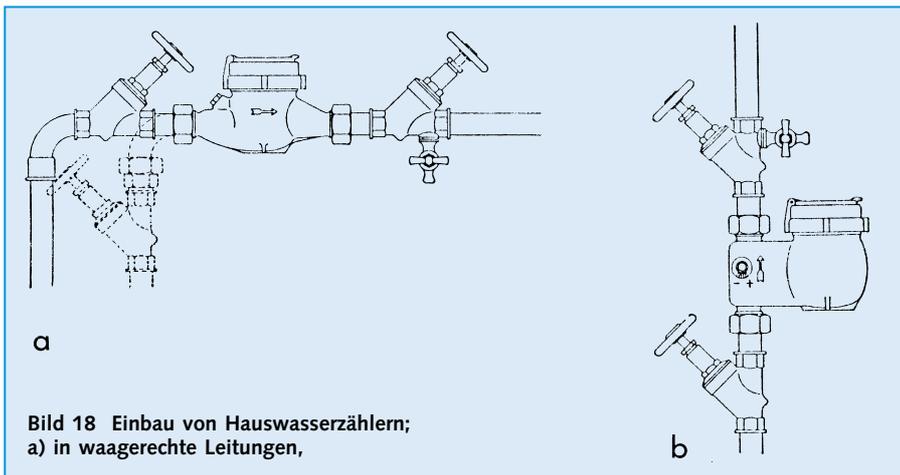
Einbau von Hauswasserzählern; a) in waagerechte Leitungen,
